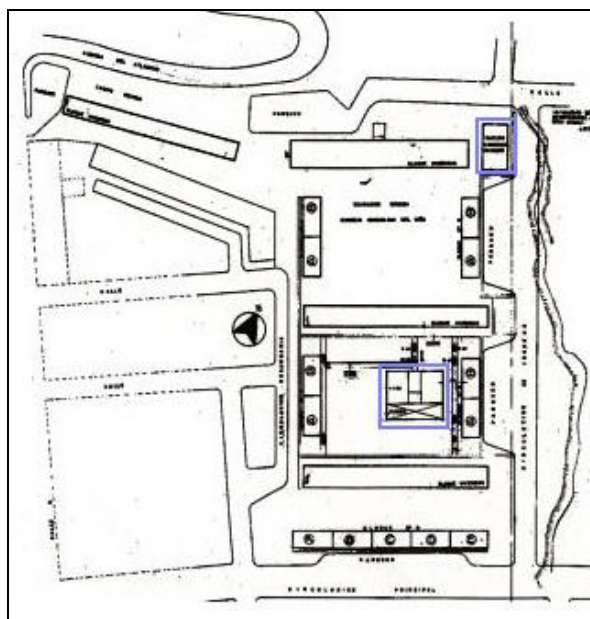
i. UR Artigas. Plano de Conjunto, las áreas destacadas corresponden a obras posteriores al período en estudio (1958)
